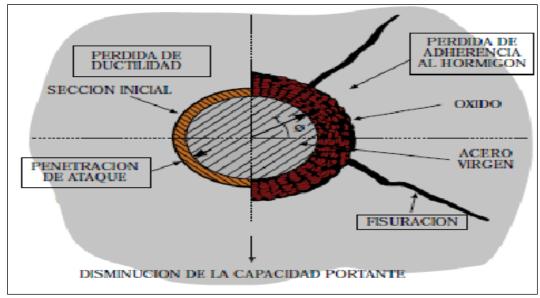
Consecuencias de la corrosión de barras embebidas en concreto. (Rondón, C. 2005).
